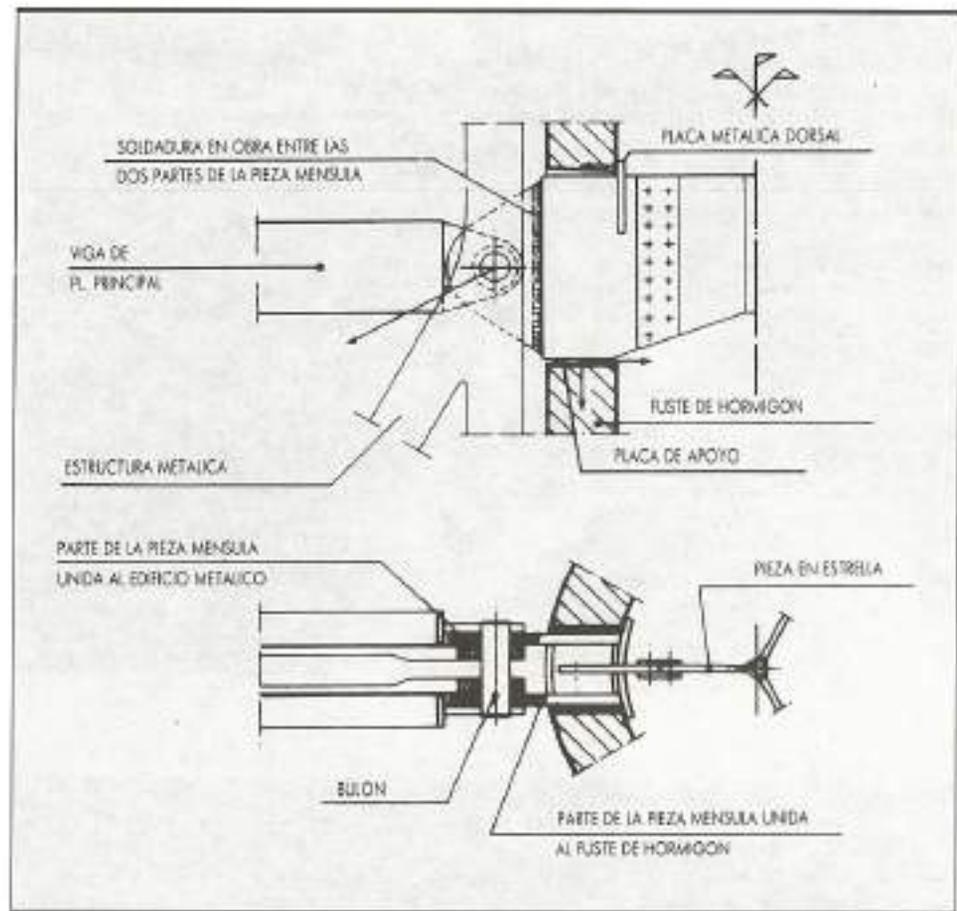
Disposición de las piezas ménsula y en estrella de una planta principal.
